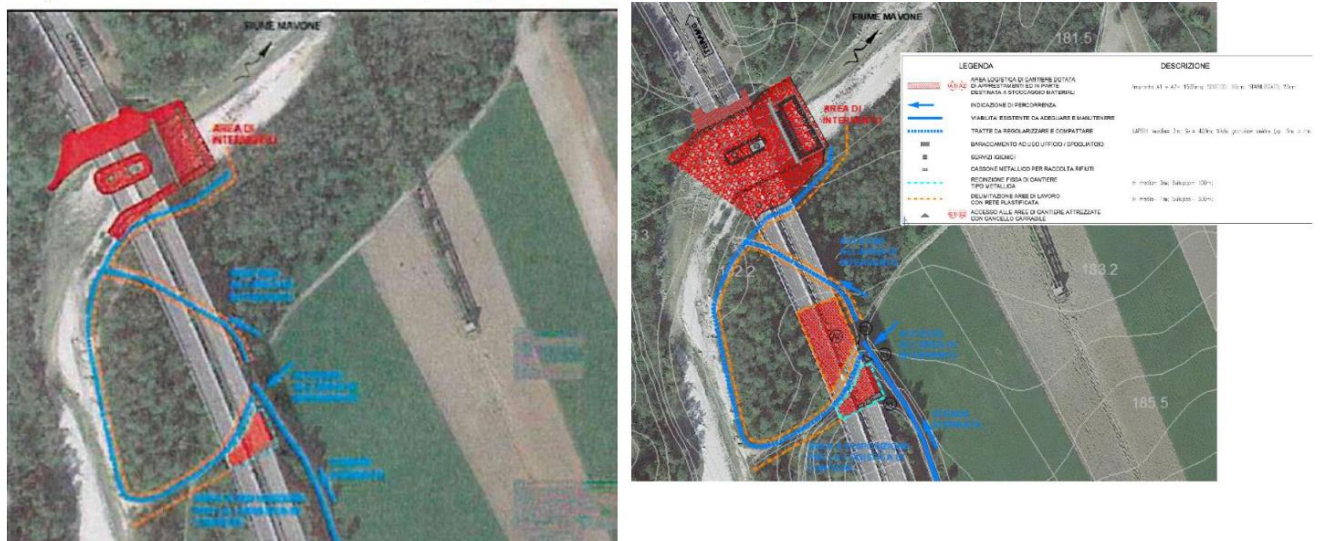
Planimetria di cantiere di progetto definitivo e esecutivo per gli interventi in corrispondenza del viadotto San Rustico
